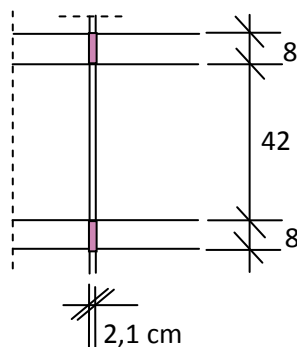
Auflagerfläche Senkrechte Schalhaut – Querträger
